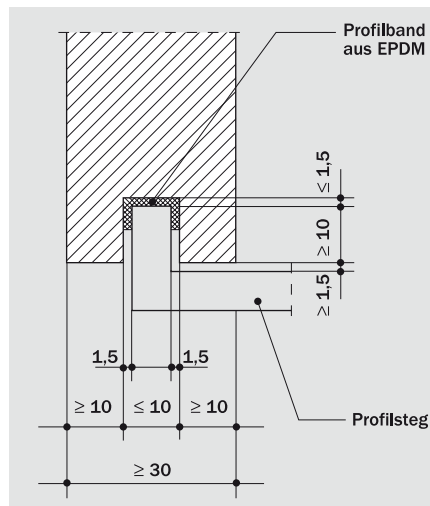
Nicht sichtbare Befestigung mit Profilstegen
